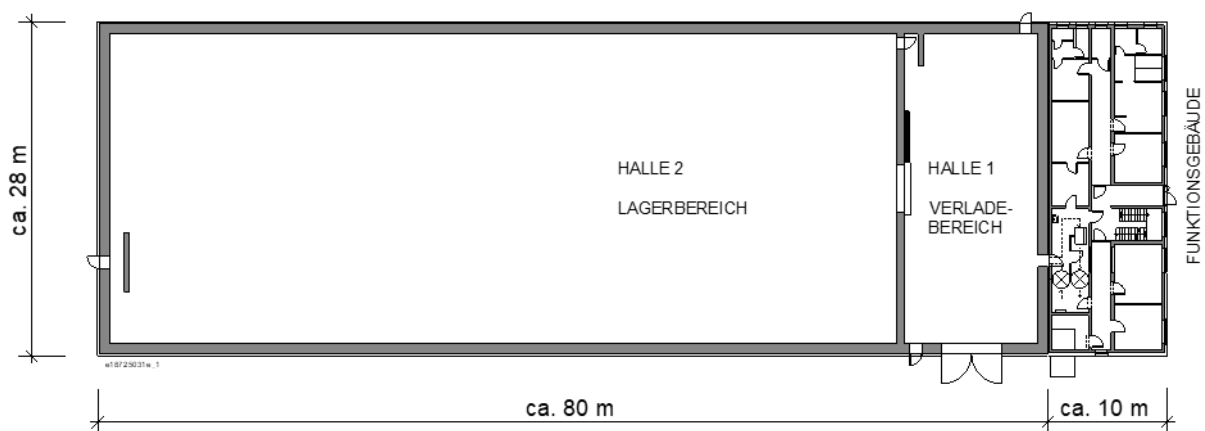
Schematischer Grundriss der TBH-KBR
